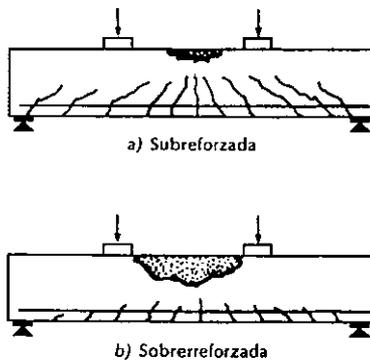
grietamiento en la falla de vigas sujetas a flexión.
